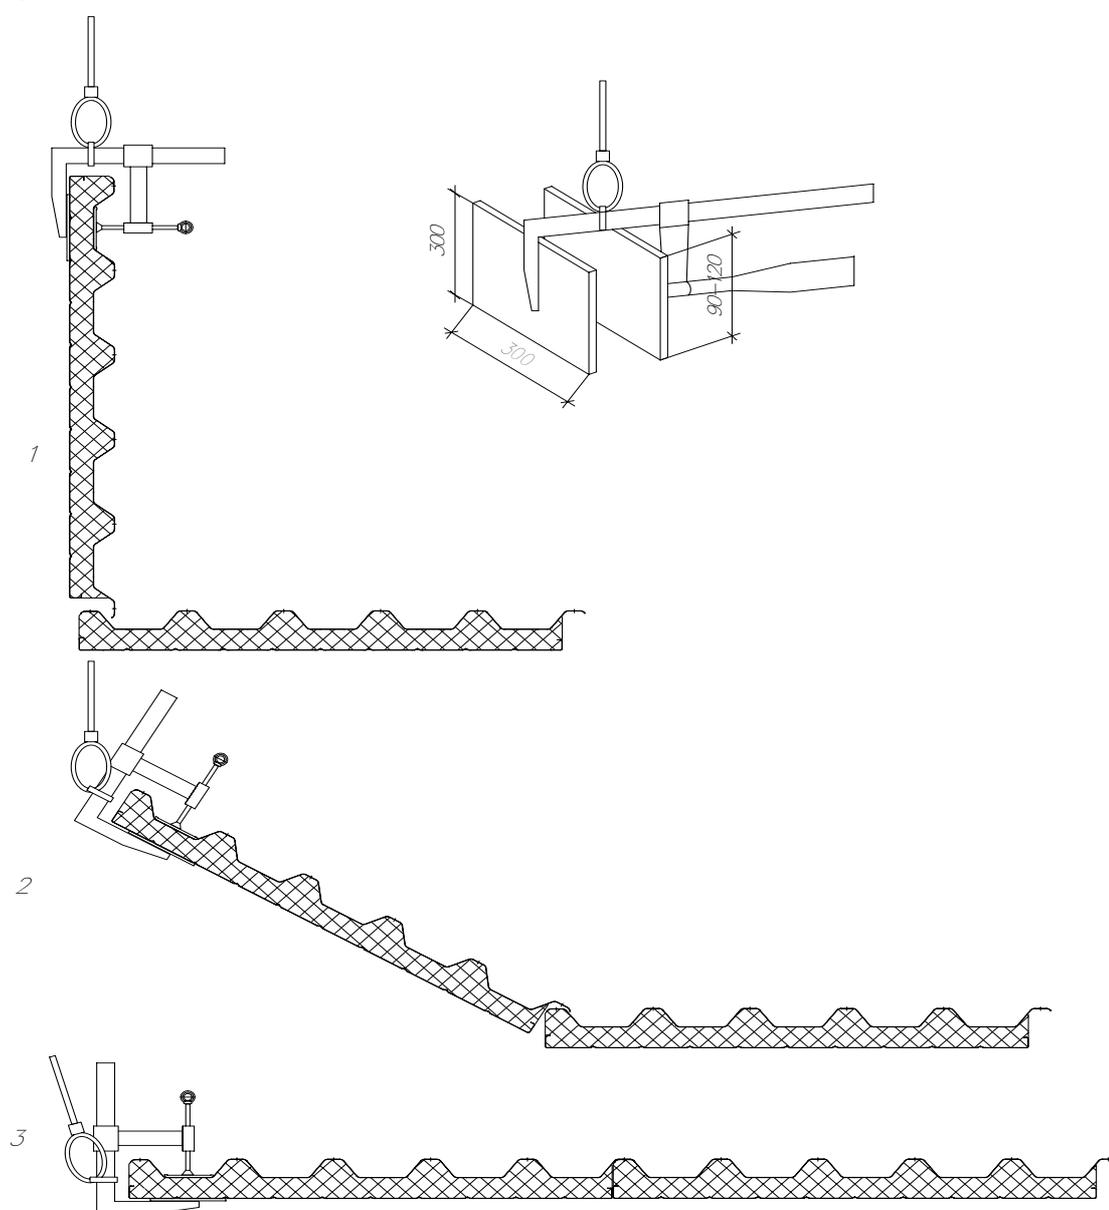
Транспортирование и укладка кровельных панелей на месте монтажа
